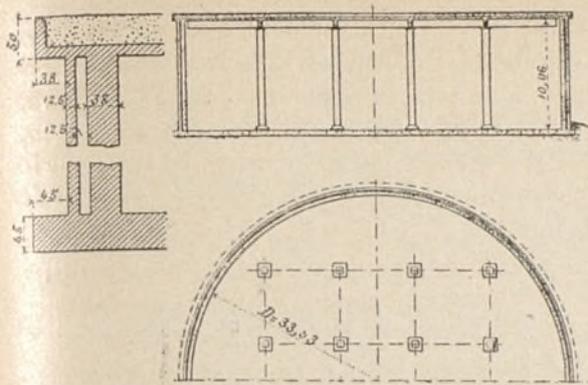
a 3. — Alzado, reimplanto y detalle de uno de los depósitos de hormigón armado de Arausas Pass.
